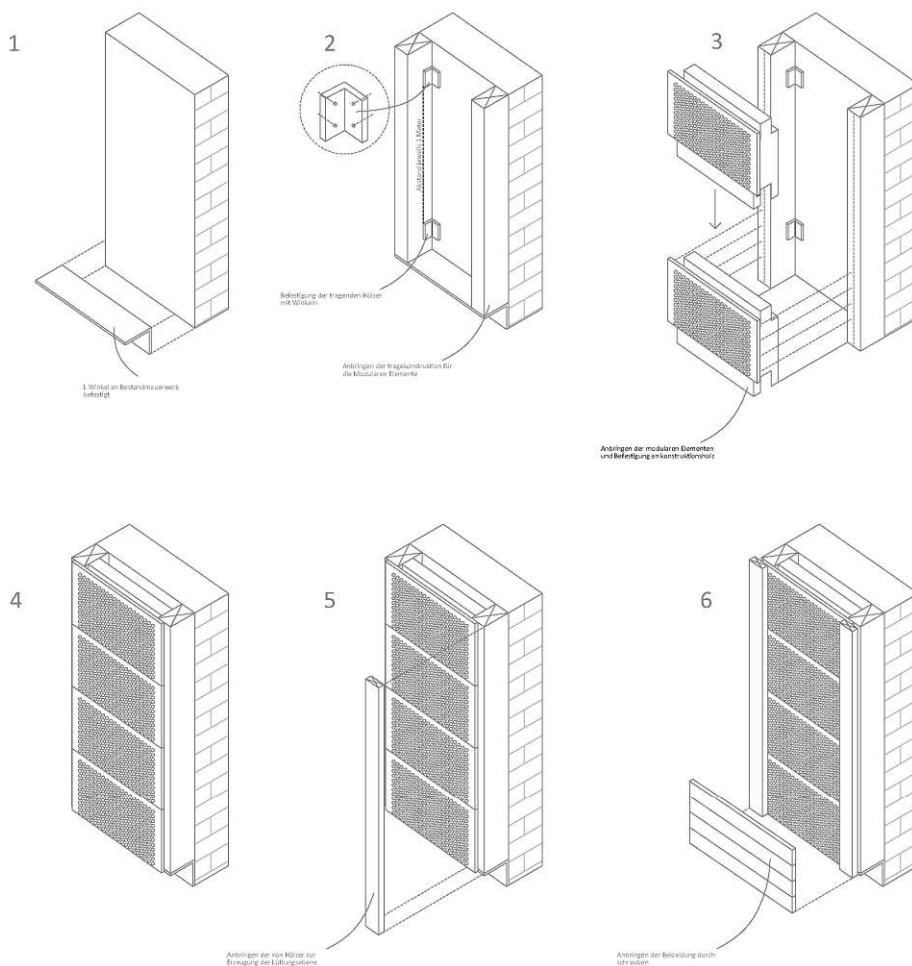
V1 Montageanleitung für den Aufbau der Fassade
